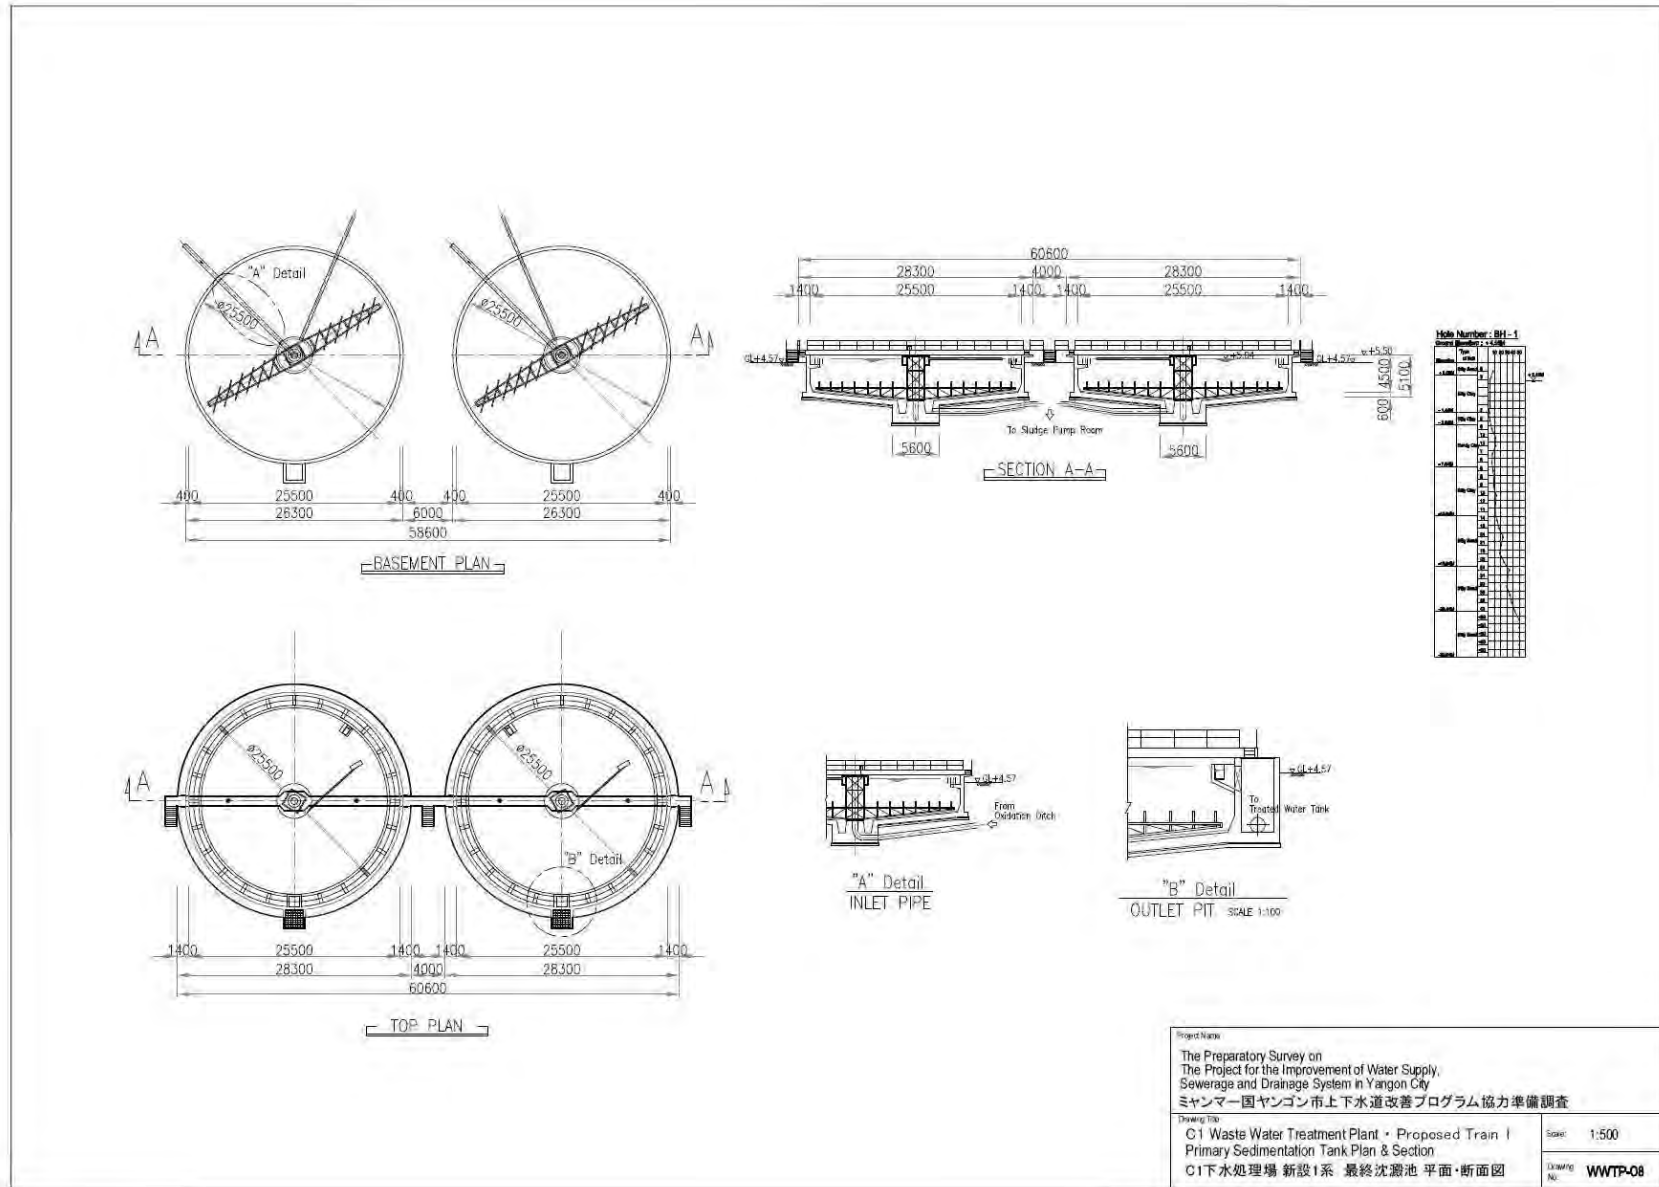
最初沈殿池 平面図・断面図（既設系-新設）
